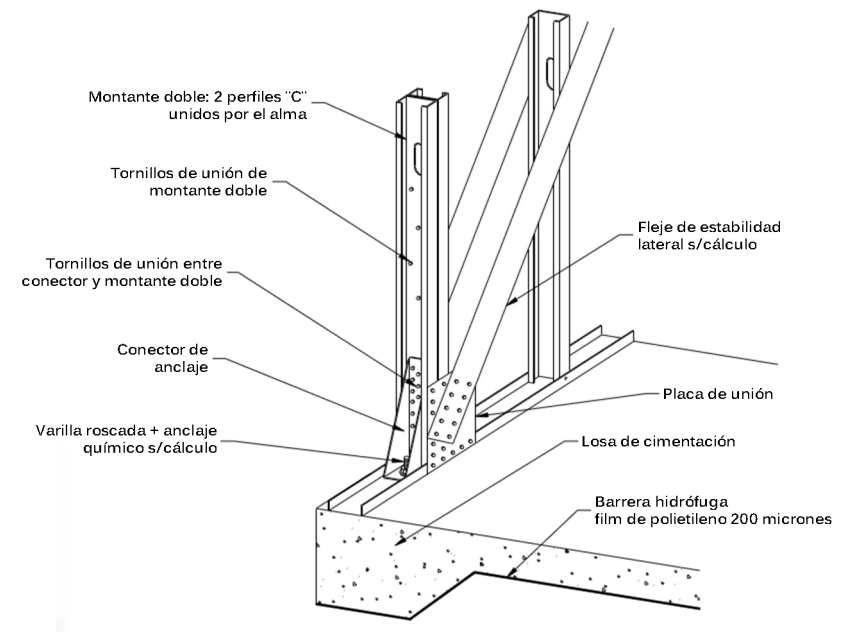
Detalle de la platea sobre terreno natural.
